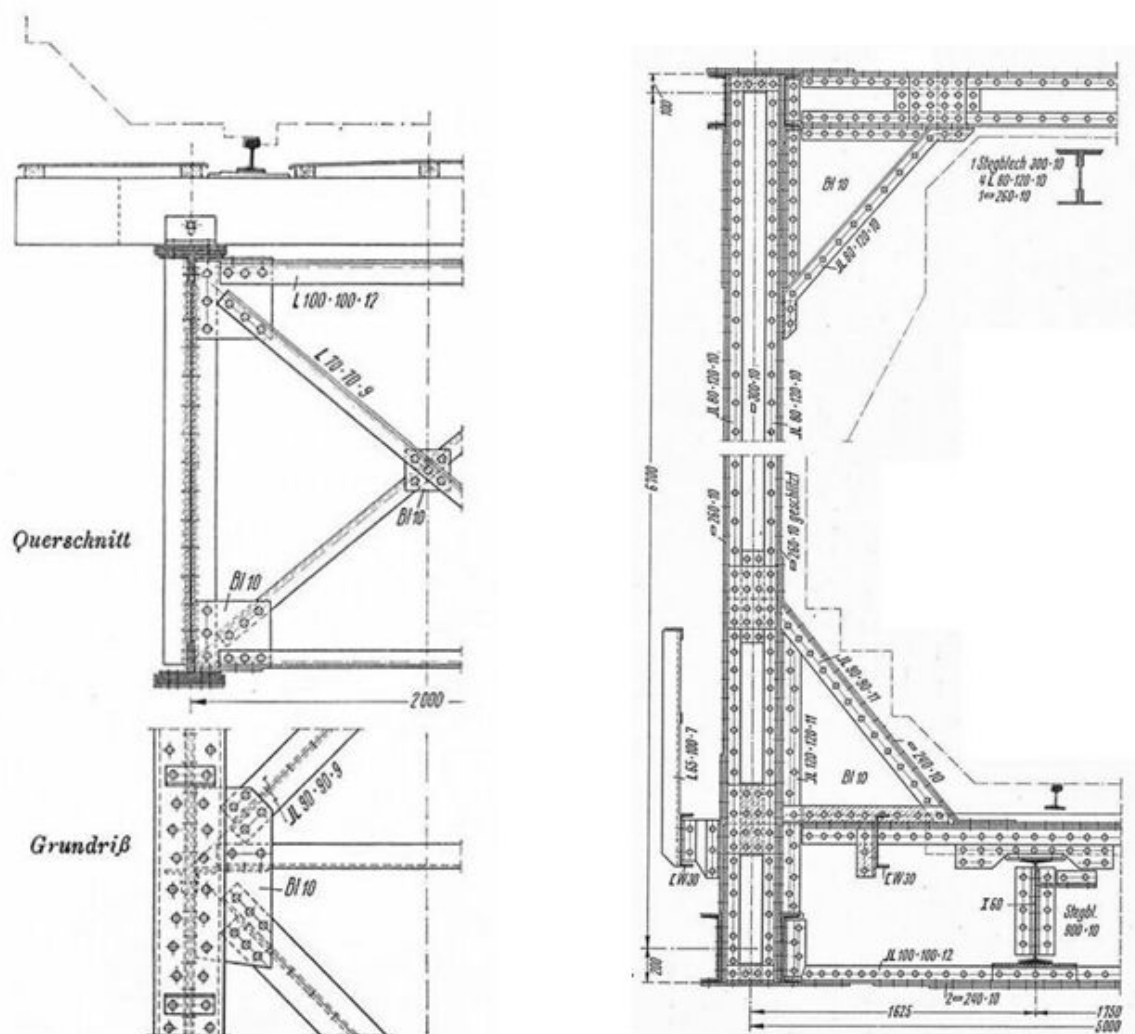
Grundriss der Trattenbachbrücke
